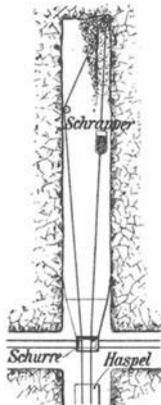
Grundriß einer Schrapper-Förderanlage für den Salzbergbau.
